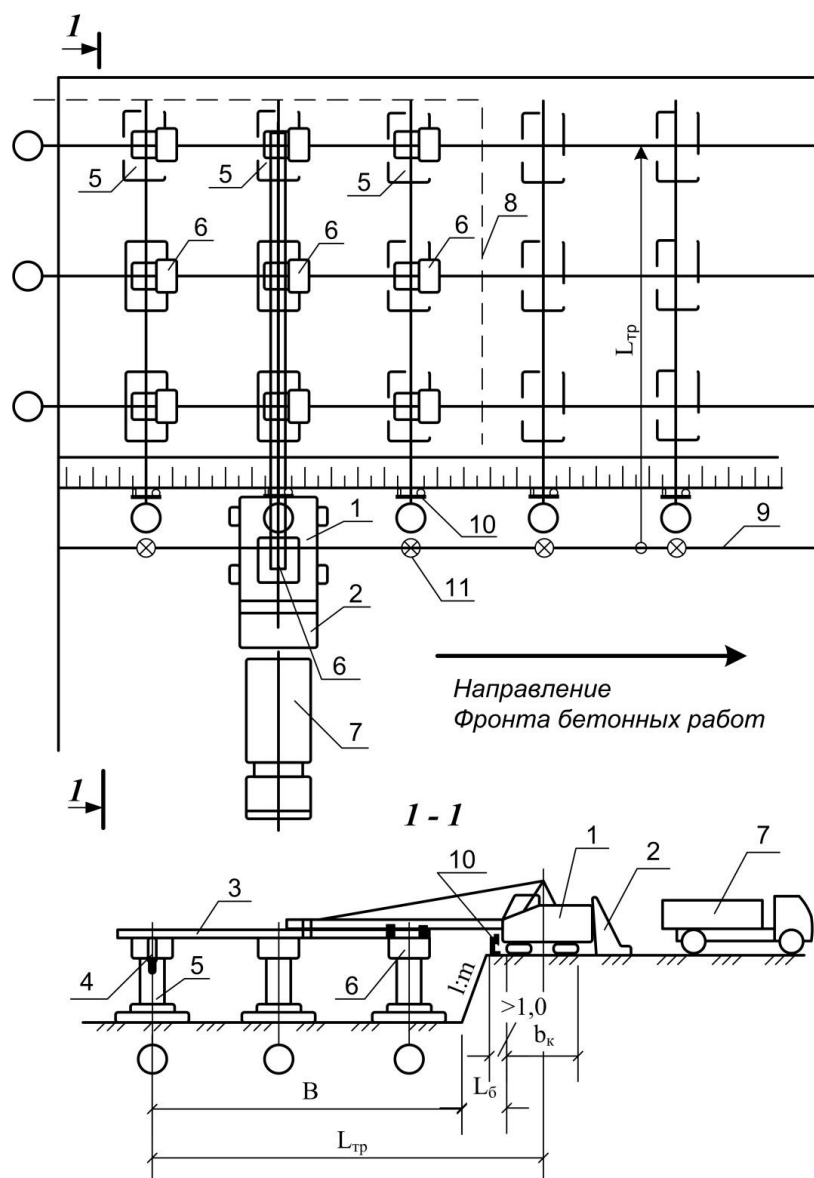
Технологическая схема бетонирования фундаментов при помощи бетоноукладчика:
